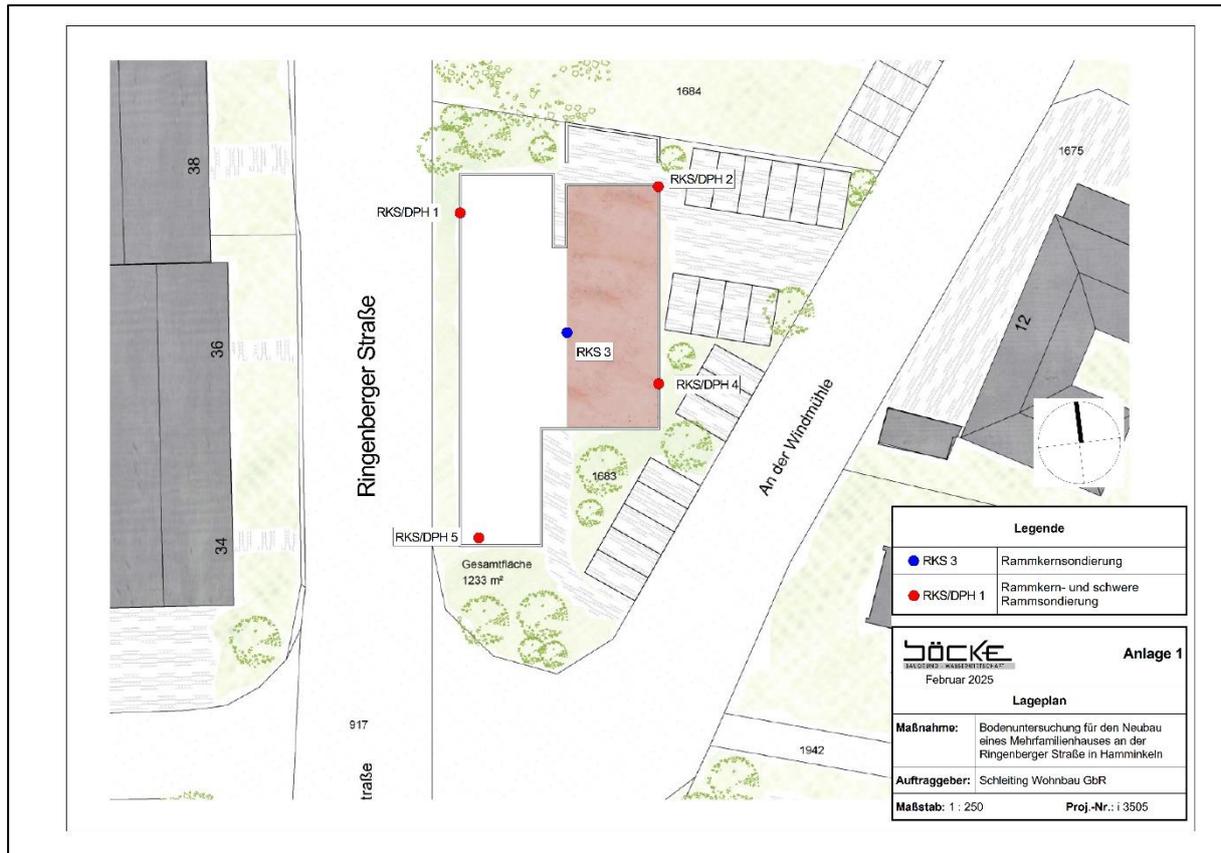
Lageplan der durchgeführten Rammkernsondierungen
